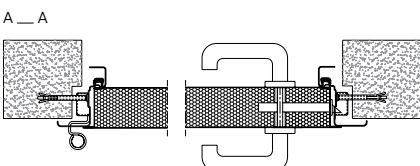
Coupe horizontale d'un bloc-porte d'extérieur ECO avec bâti angulaire
